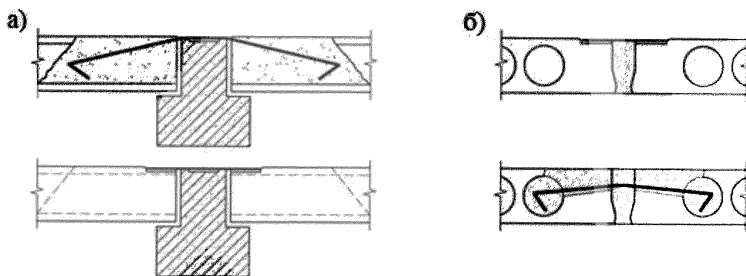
Варианты соединения плит перекрытия с ригелями (а) и между собой (б)
